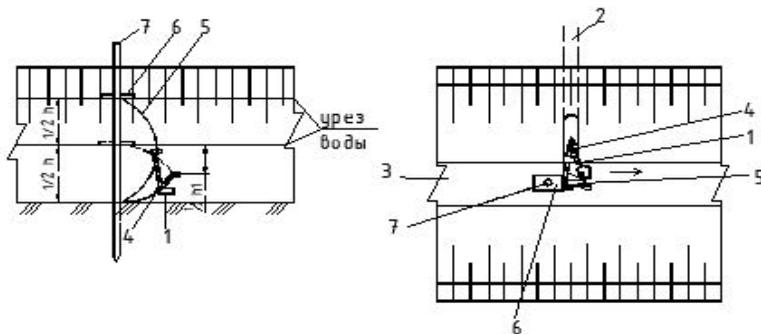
Устье коллектора с поплавковой г-образной насадкой: 1 – устье; 2 – дренажный коллектор; 3 – канал; 4 – гибкий патрубок; 5 – эластичная диафрагма; 6 – поплавок; 7 – направляющая штанга
